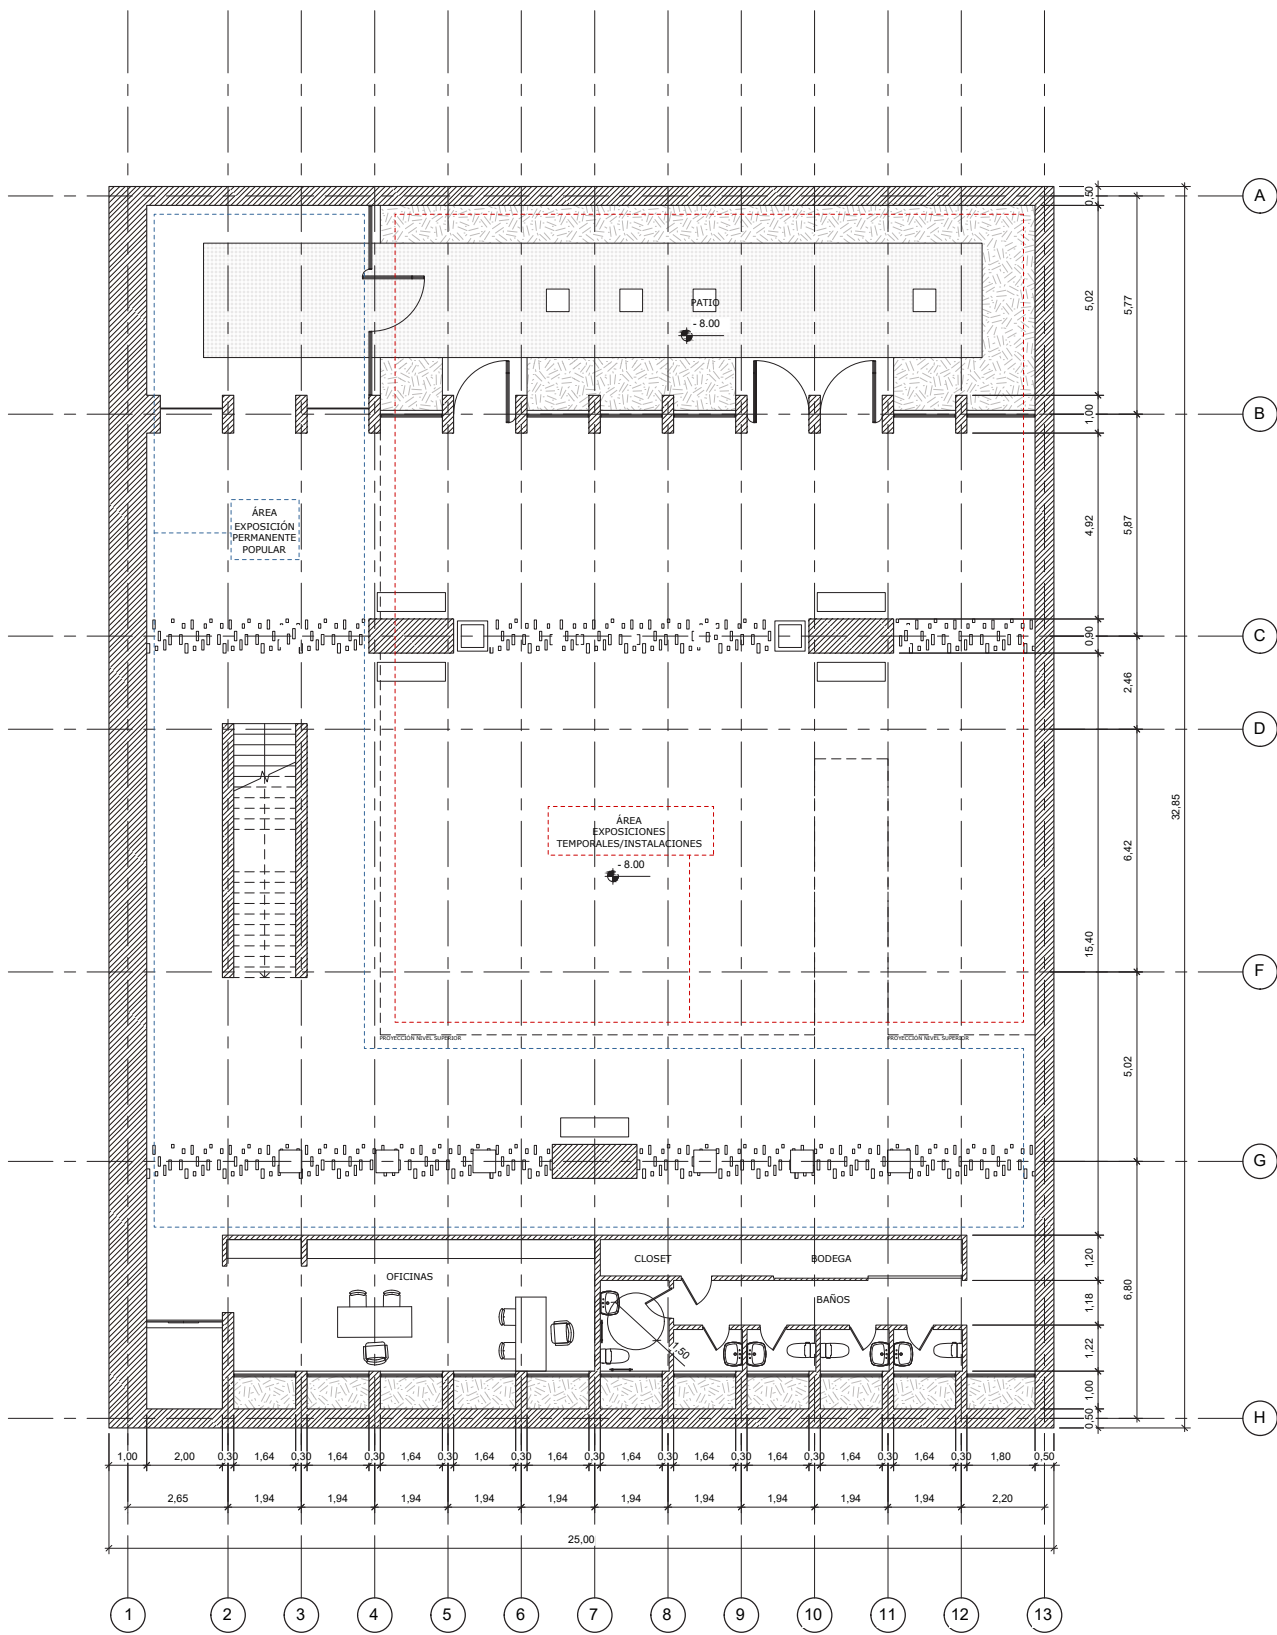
Planta nivel -2. Esc.1:200. PRELIMINAR.
